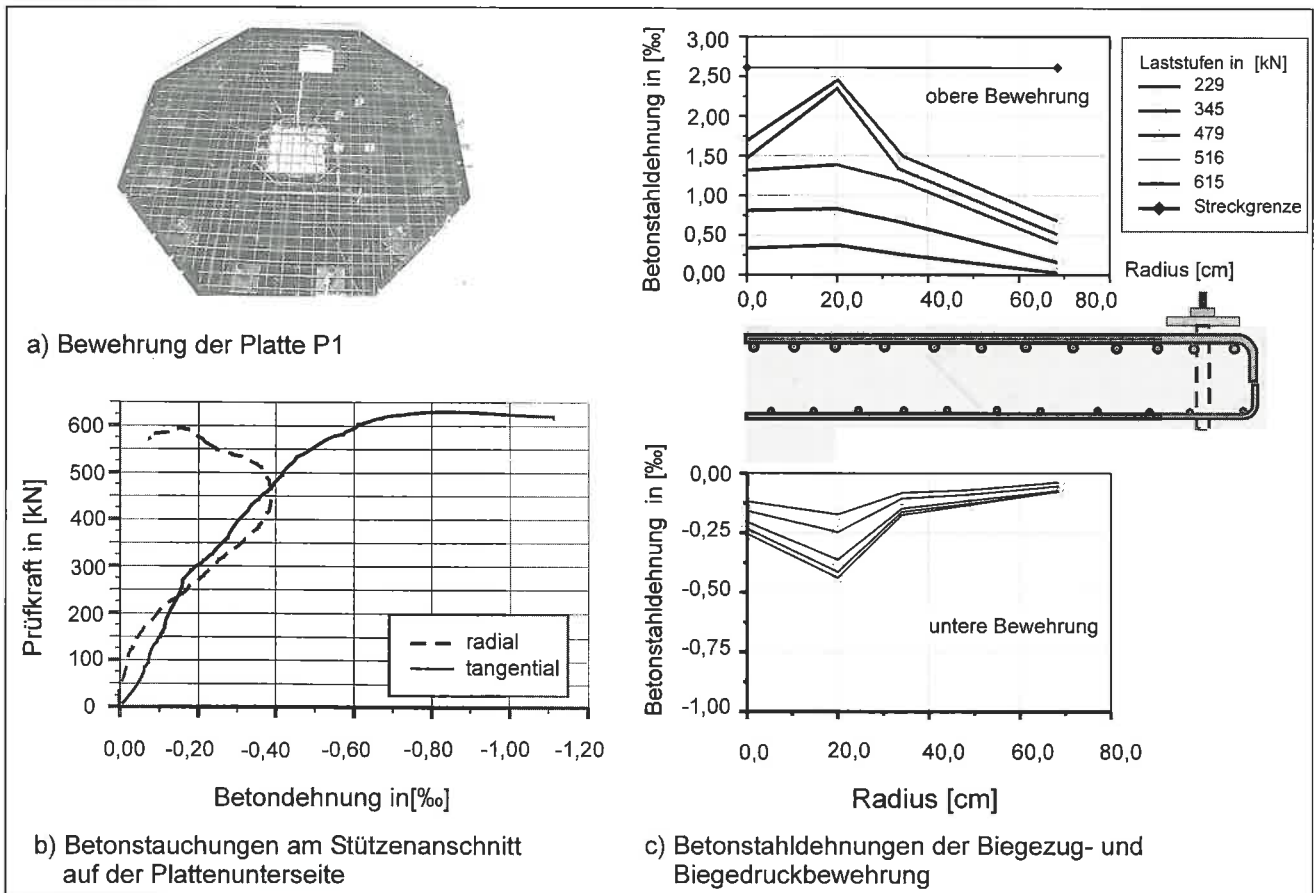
Betonstauchung und Betonstahldehnung des Versuchskörpers P1 [8]
